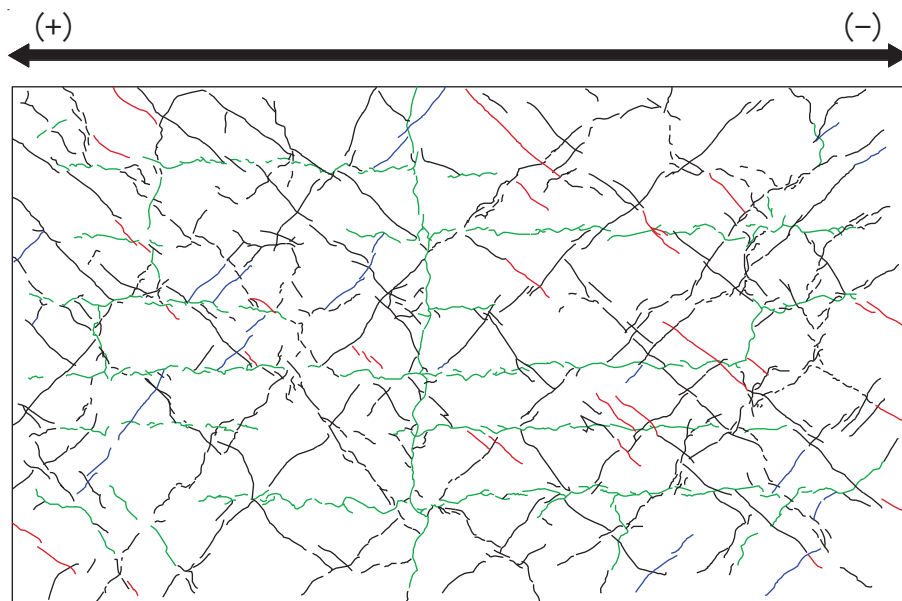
(10) 乾燥試験体 [1] 1/333rad. におけるひび割れ図
